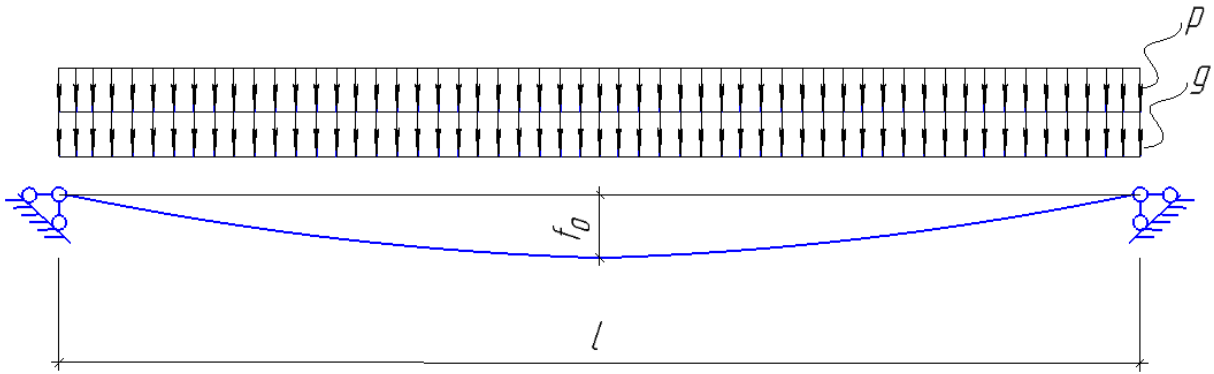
Расчетная схема покрытия прямоугольного плана, нити расположены параллельно
